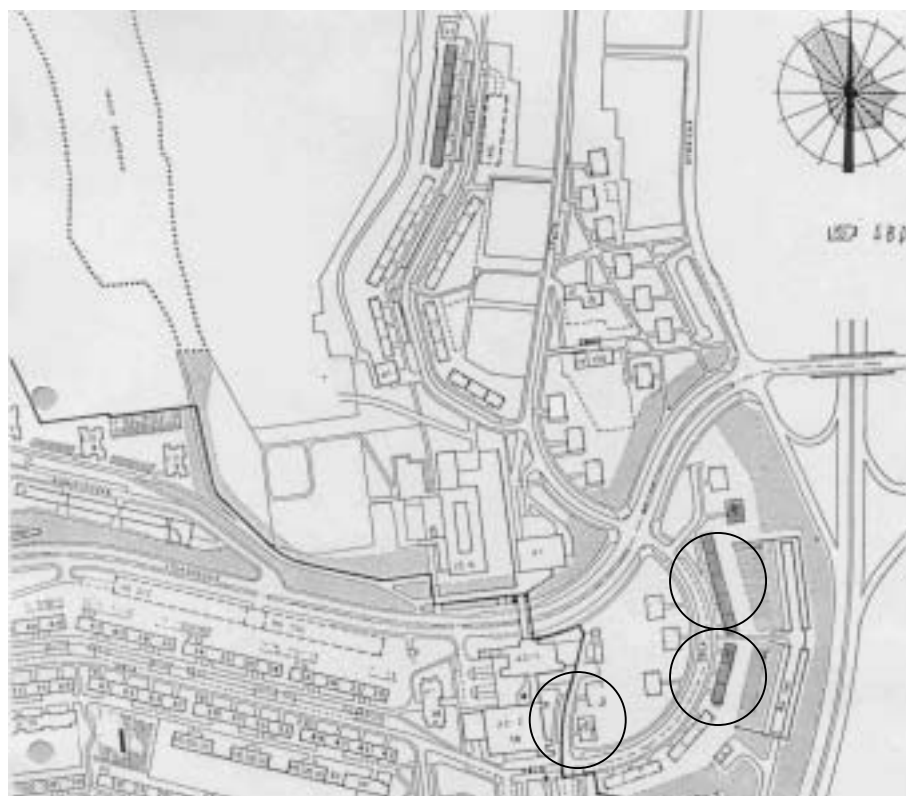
Planungsgebiet mit gekennzeichneten Planungsobjekten
